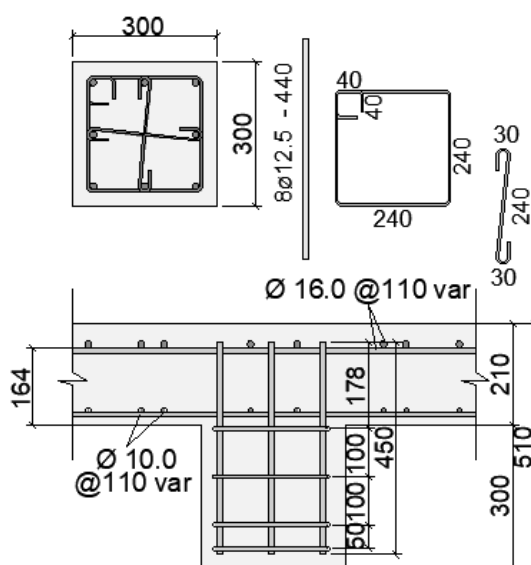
Armadura dos pilares (Autora, 2023).
